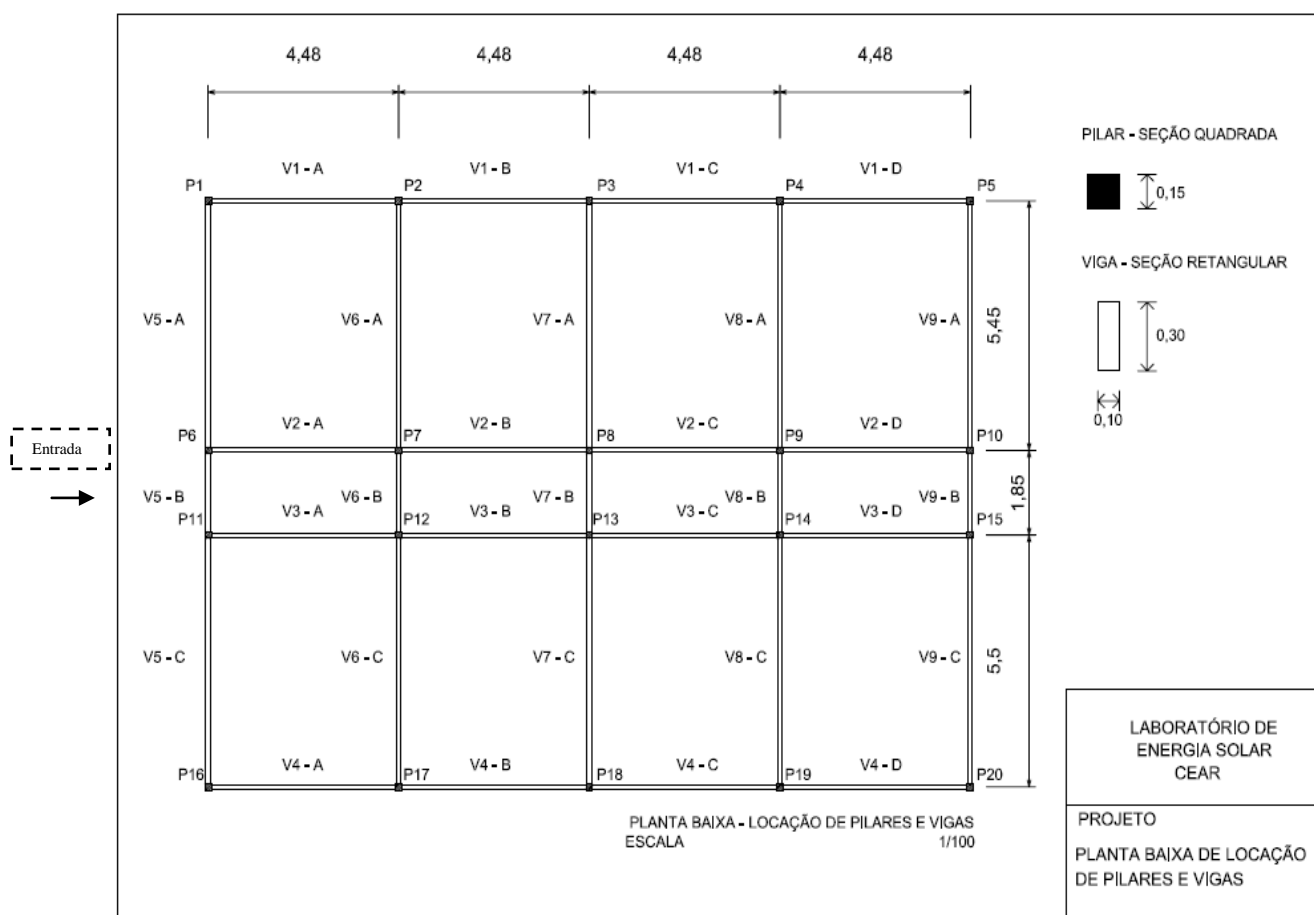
Planta baixa de locação de pilares e vigas LABRADS.
